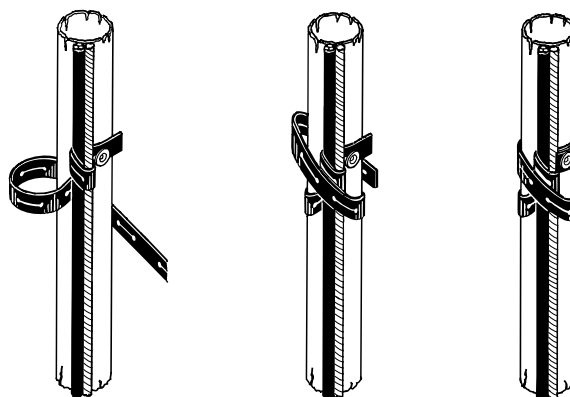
Instalação das abraçadeiras de fixação de cabos
